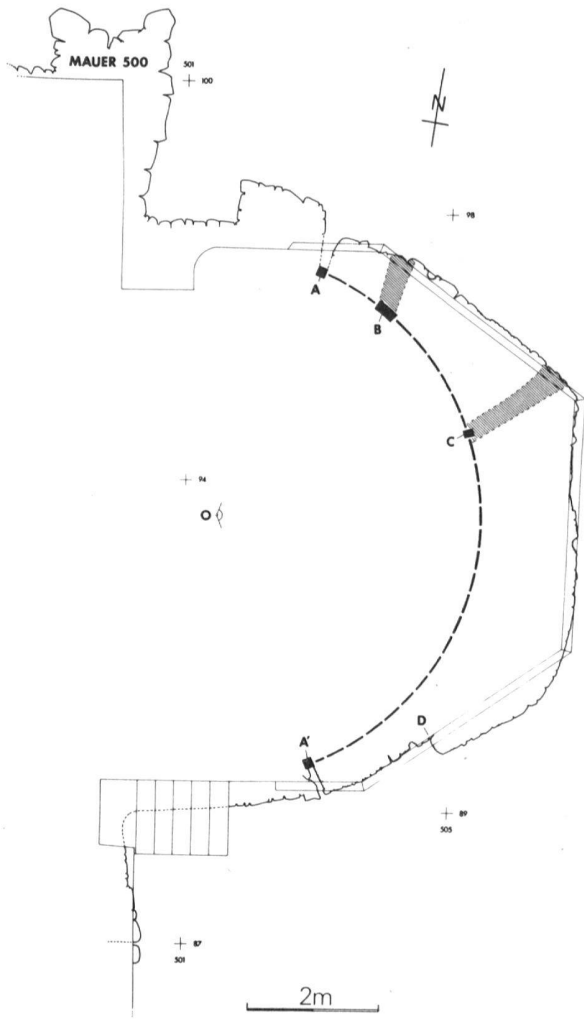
Kerzers. Chorgrundriss mit Sondierschnitten und halbrundem karolingischen Chorabschluss
